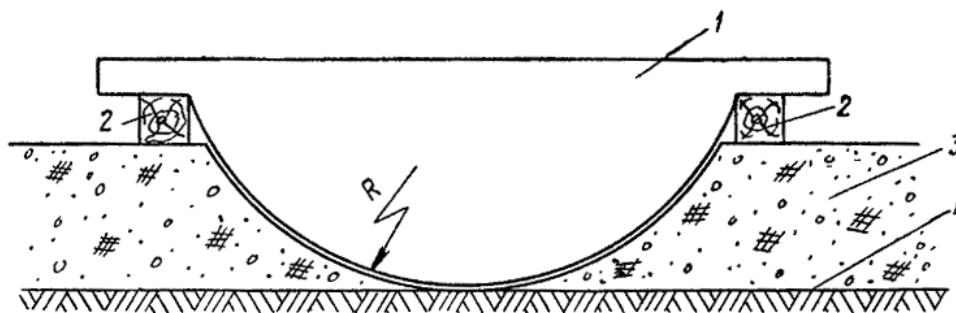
Схема установки шаблона для вырезки грунтового ложа в нулевом слое: 1 – шаблон; 2 – деревянные брусья; 3 – нулевой слой; 4 – уровень верха подушки (не должен превышать нижней отметки грунтового ложа)
